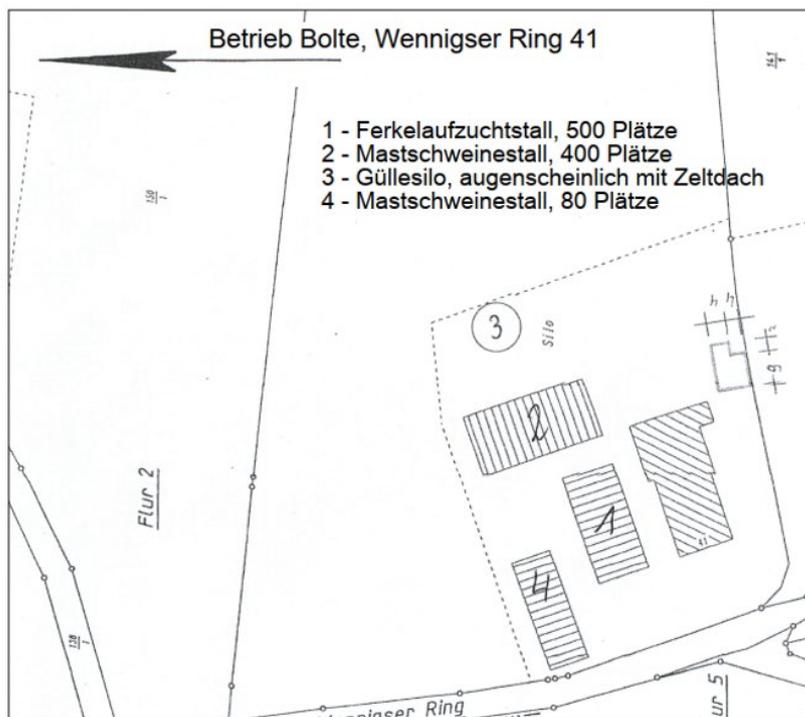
Lageplan mit genehmigten Tierzahlen Hof Bolte
